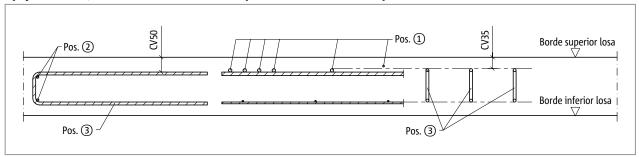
Schöck Isokorb® XT tipo C: Armadura in situ esquinero externo (sección XT tipo C-L-CV50, vista XT tipo C-R-CV35)
